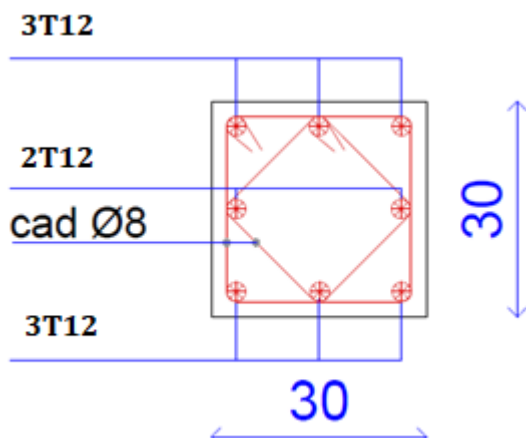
Schéma de ferrailage des poteaux (30*30)cm² de 9^{ème} étage et terrasse .
